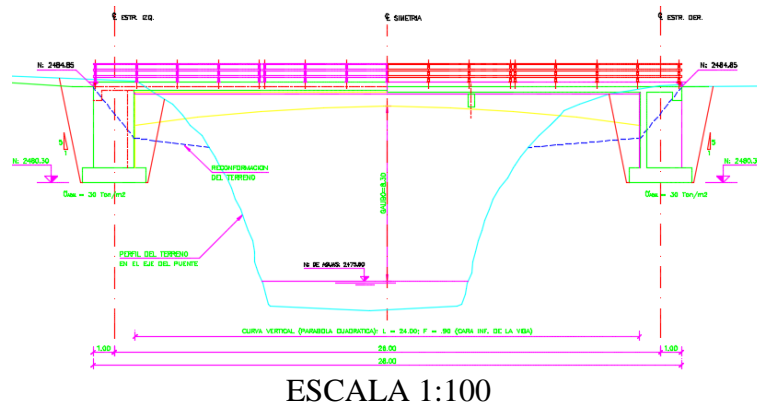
Vista en elevación puente de hormigón armado Isla Santiago.
